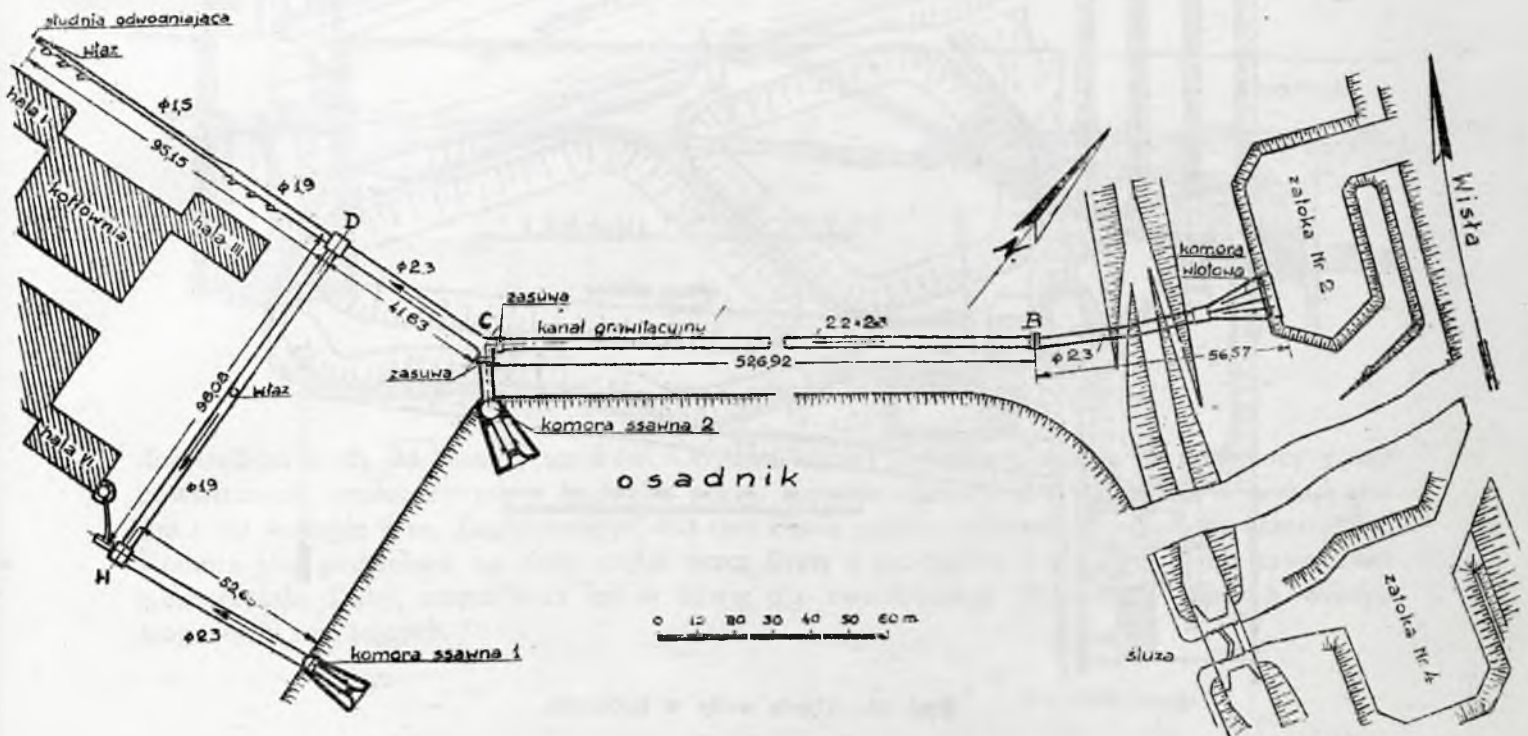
Pierwotne ujęcie wody w Warszawie.
